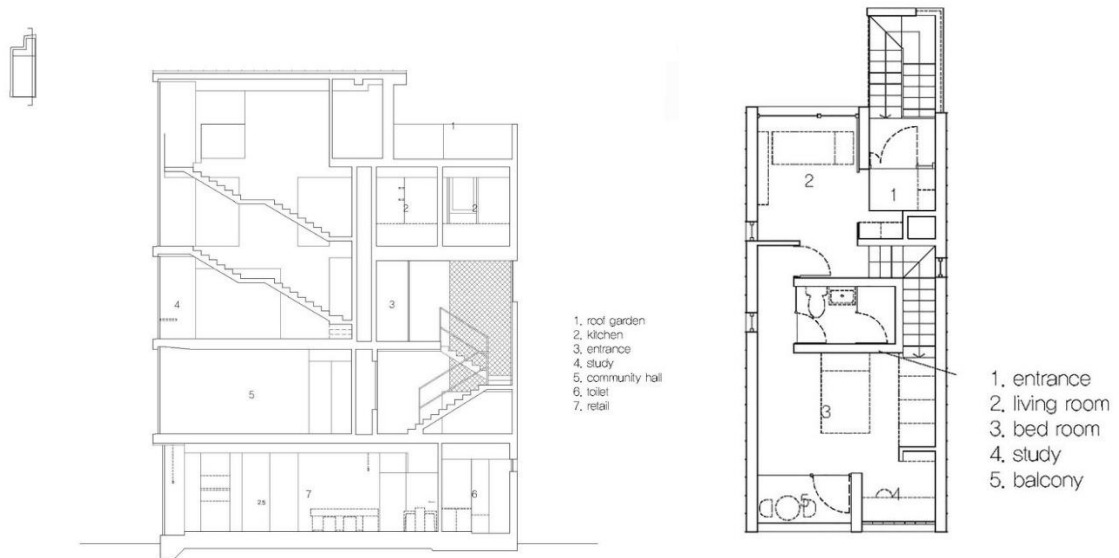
Corte longitudinal da Casa Busan e planta do piso 3.
